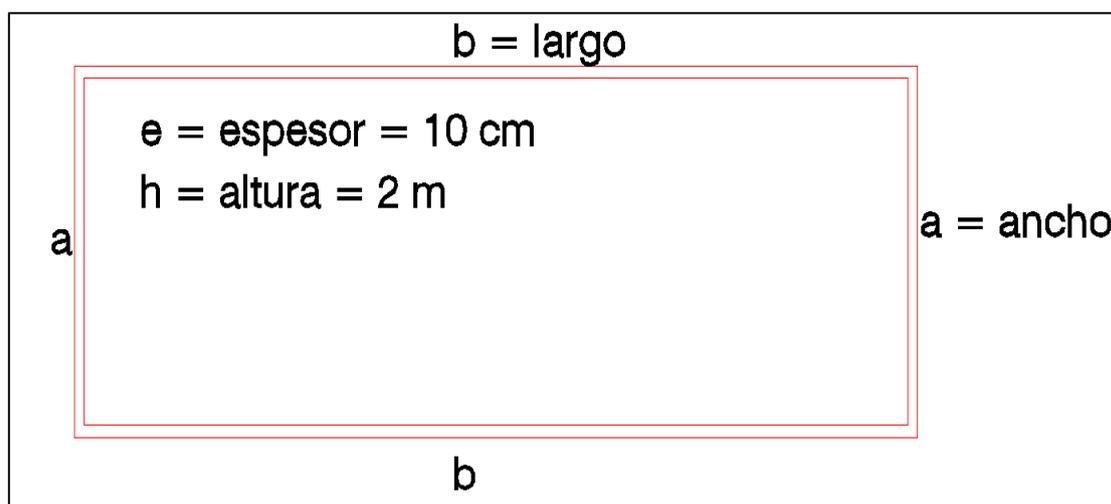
Referencias para el cálculo de área de encofrado y volumen de concreto
